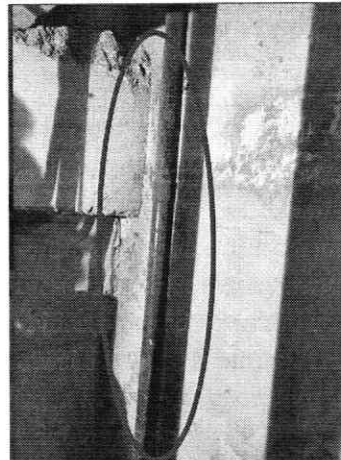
Instalaciones ajenas (Tuberías en el foso).
